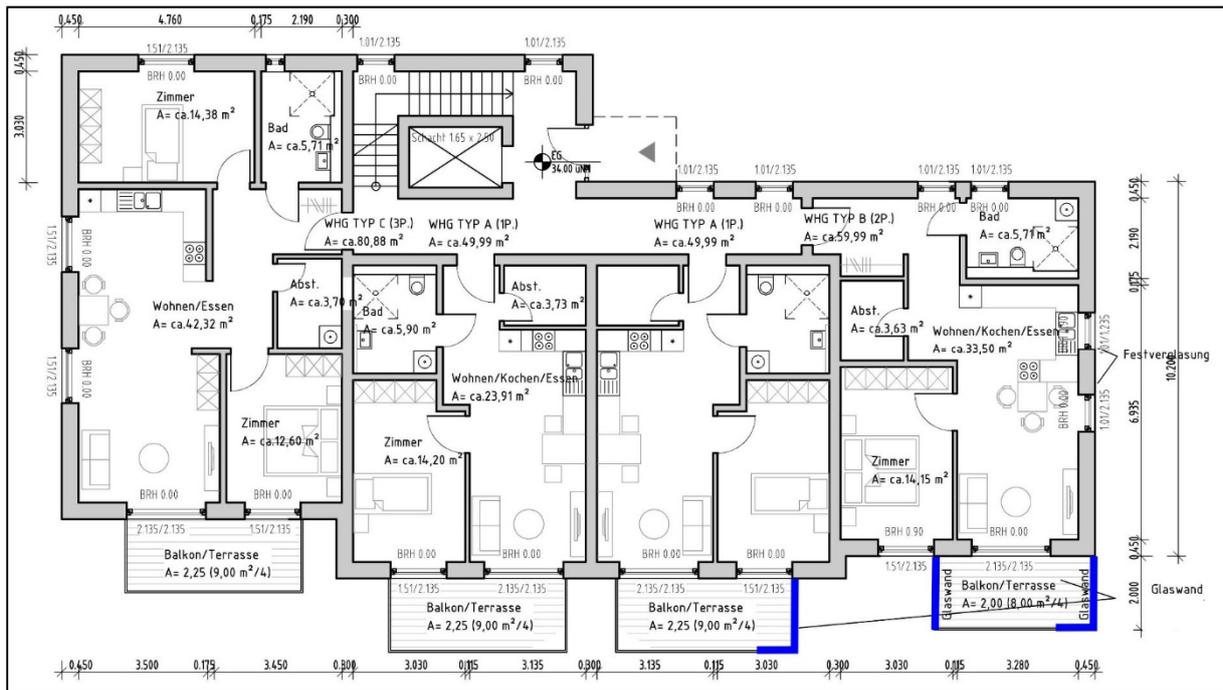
Grundriss Haus 2, Architekturbüro Ladwig (Stand: 10.02.2021)
